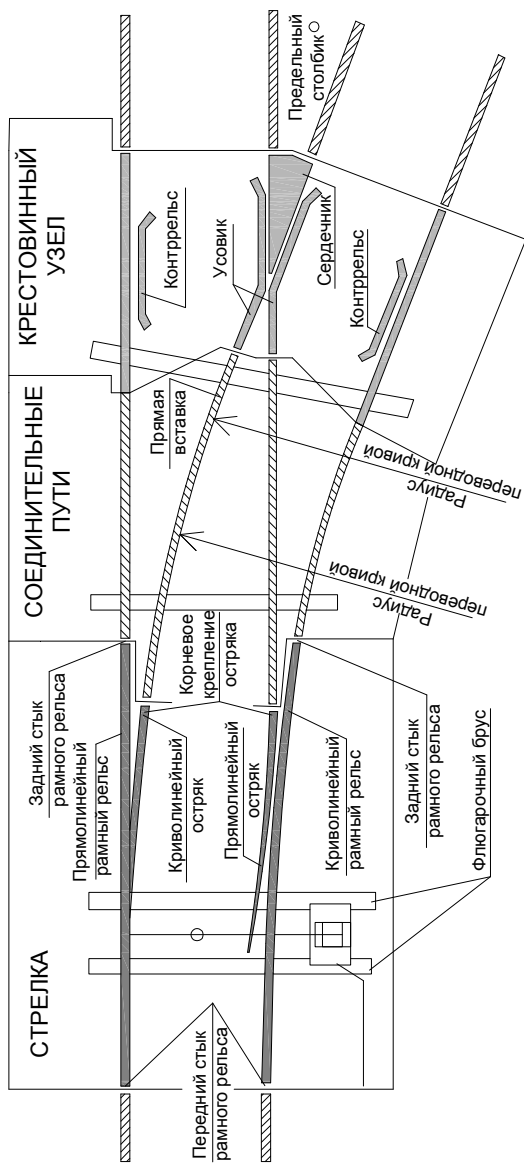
Одиночный обыкновенный стрелочный перевод
